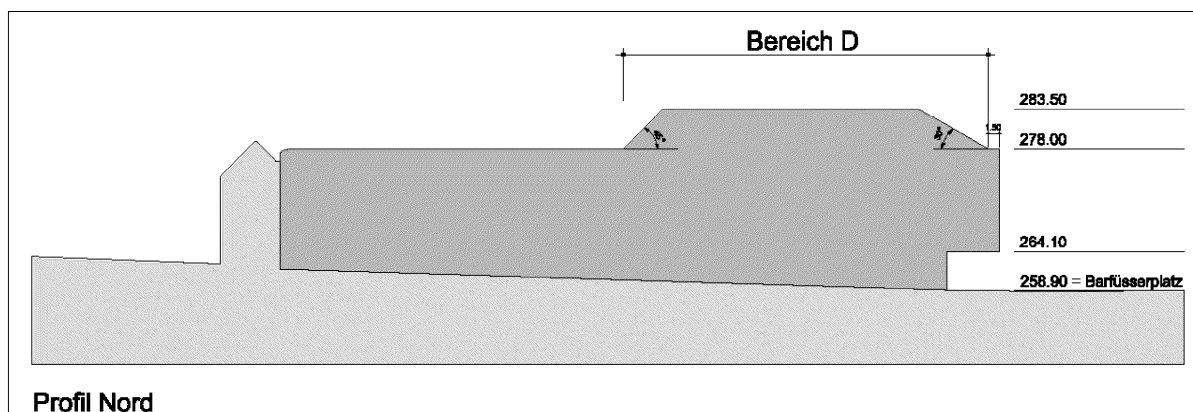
Plan Nr. 13'175. Bebauungsplan: Profil Nord. (kein Massstab)
